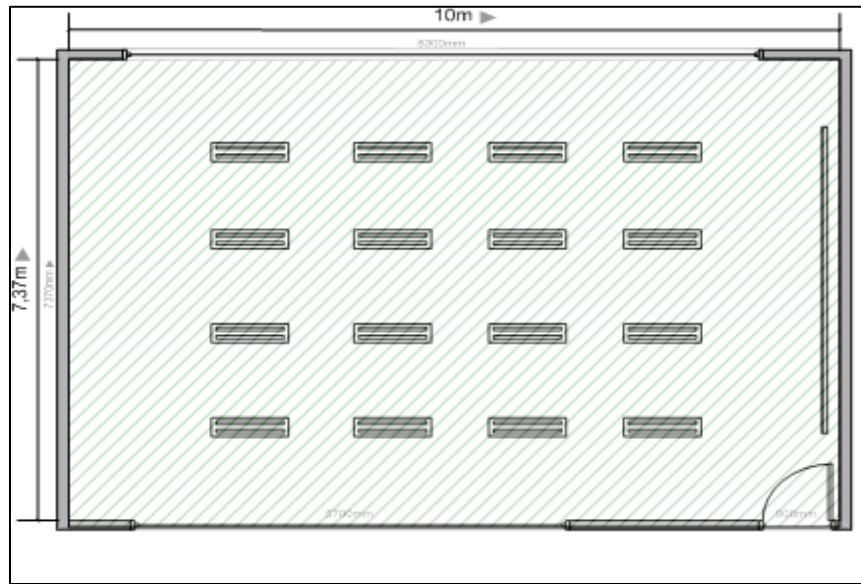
Distribución de las luminarias para las aulas de la planta baja y segundo piso
